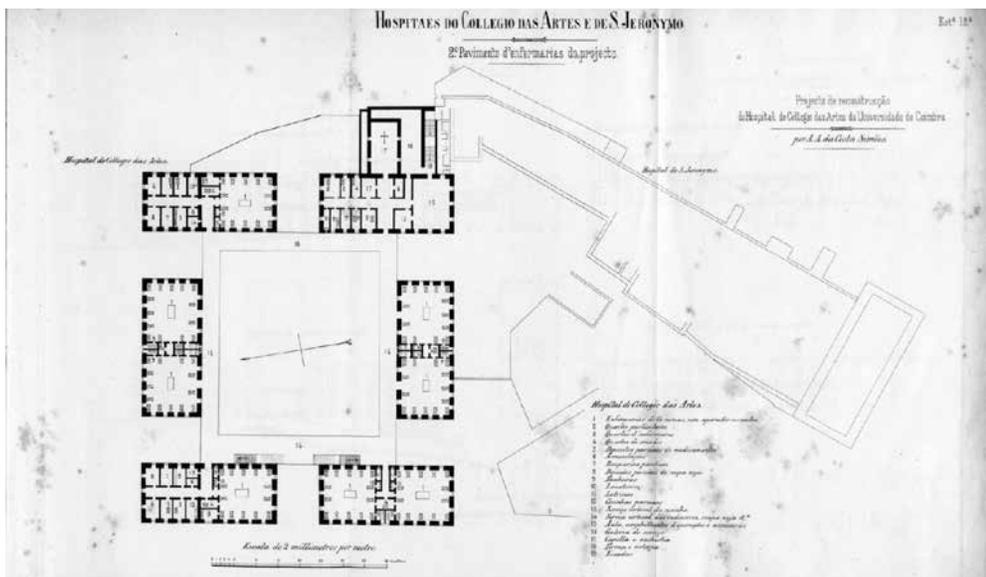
A.A. Costa Simões, *Projecto de reconstrucção do Hospital do Collegio das Artes da Universidade de Coimbra*, 2.º Pavimento, s/d (Simões, 1869: est. 12)
